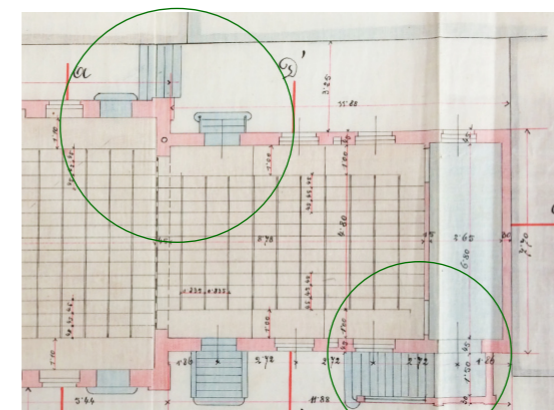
Grundriss Einreichung (1884) [ma37]
